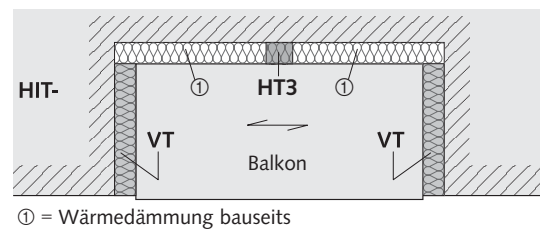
Balkon/Loggia, 2-seitig aufgelagert. Zur Aufnahme von planmäßigen Horizontallasten werden HIT-HT Elemente eingesetzt.
